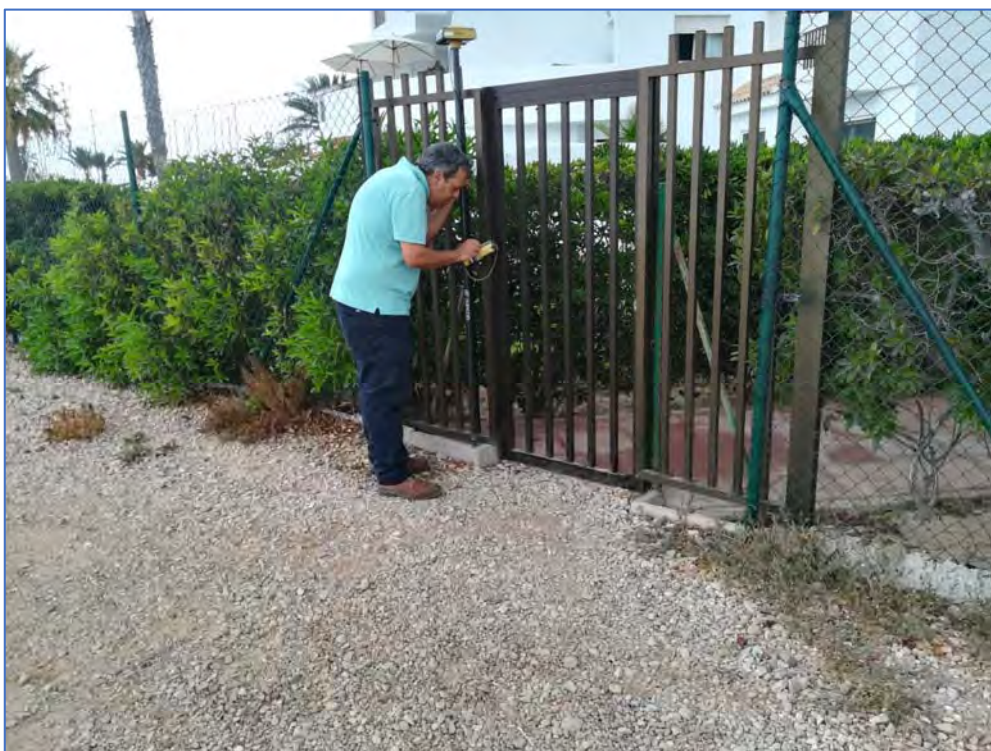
Levantamiento con GPs de vallado con las parcelas adyacentes
